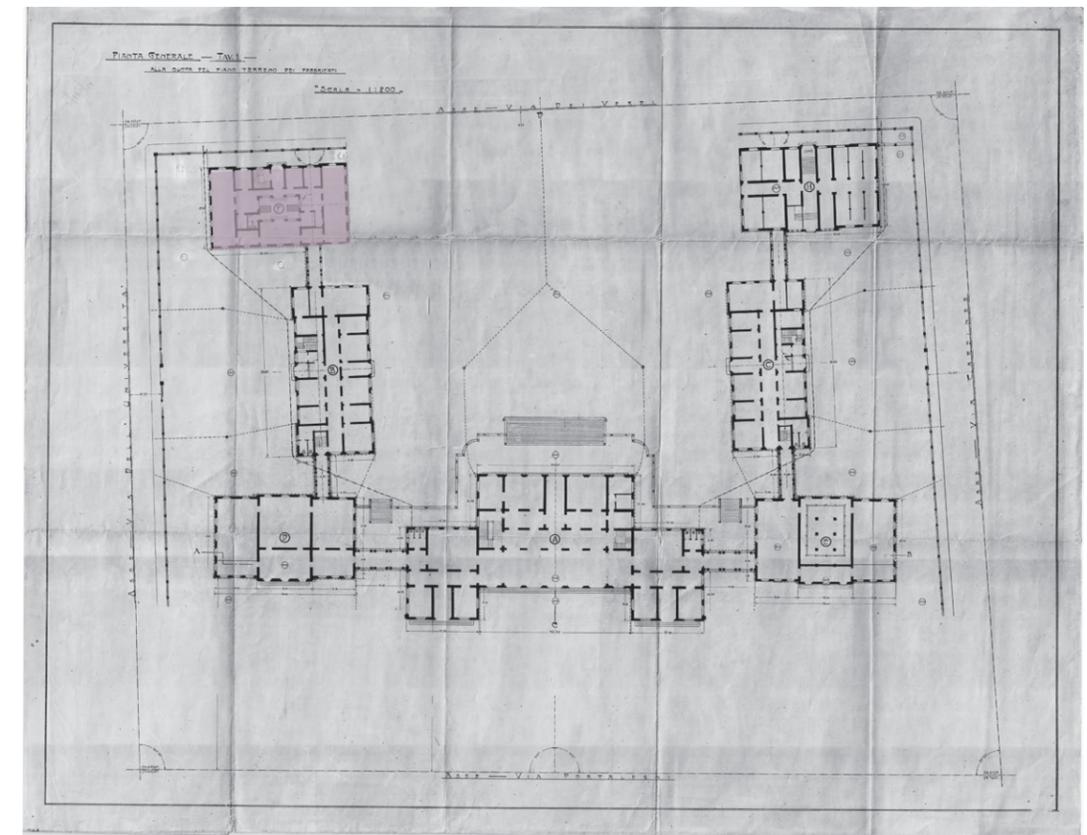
Planimetria generale in scala 1:200 con in evidenza il fabbricato F (Archivio del Genio Civile di Messina)
